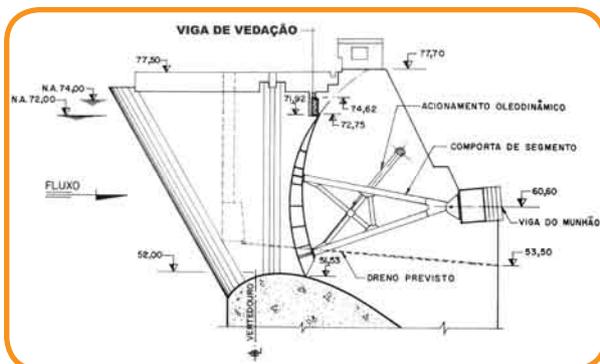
Indicação do posicionamento da Viga de Vedação, acima da Comporta do Vertedouro.
